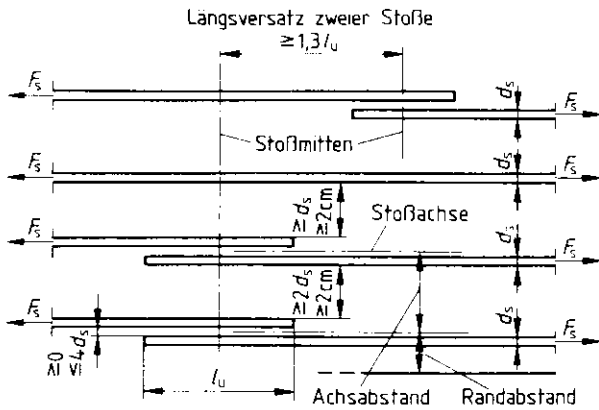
Längsversatz und Querabstand der Bewehrungsstäbe im Stoßbereich
